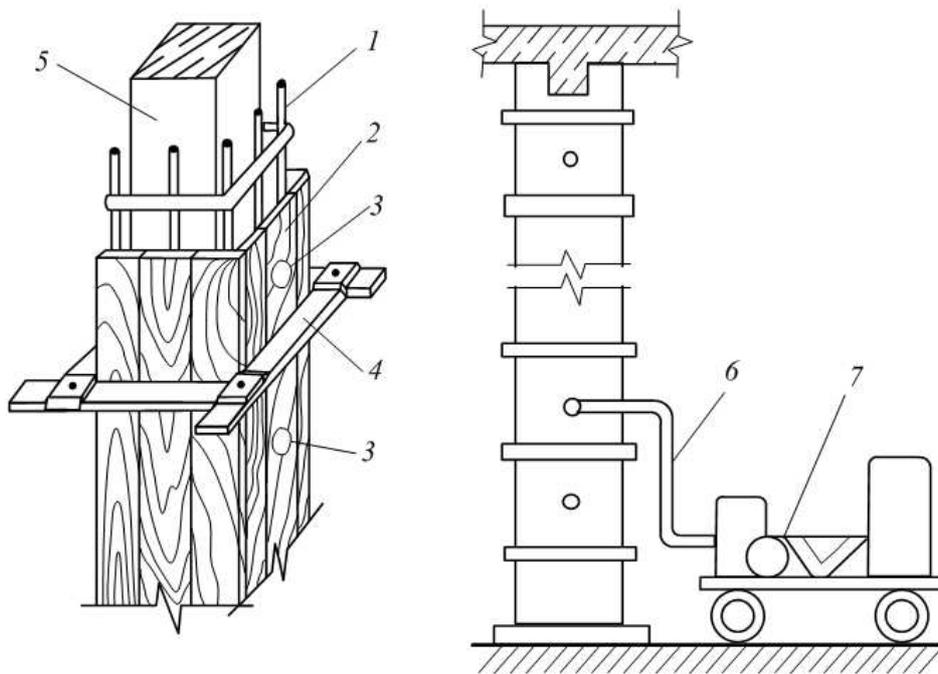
Усиление железобетонной обоймой с использованием щитовой опалубки:
